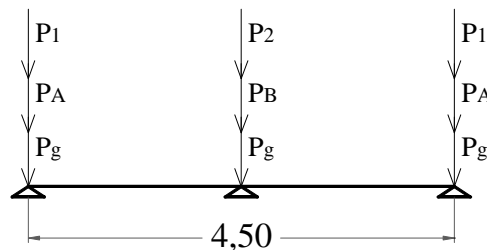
Cargas Actuantes sobre las columnas del Tanque de Reserva.
